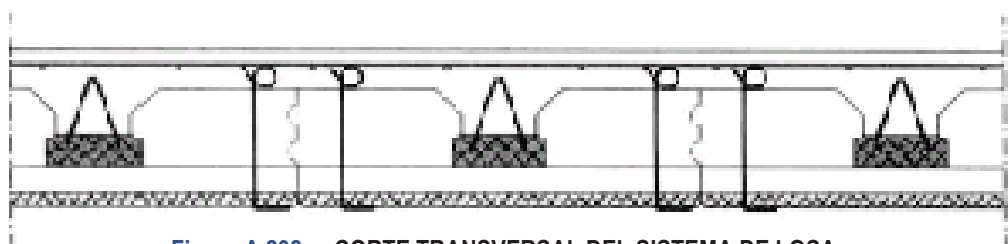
CORTE TRANSVERSAL DEL SISTEMA DE LOSA –
